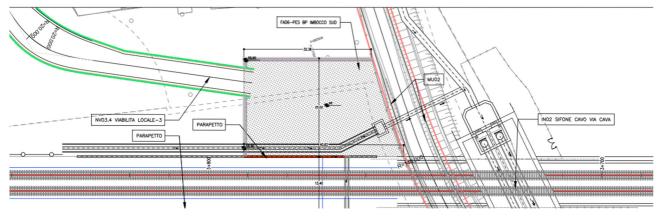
PLANIMETRIA DI PROGETTO FA06
